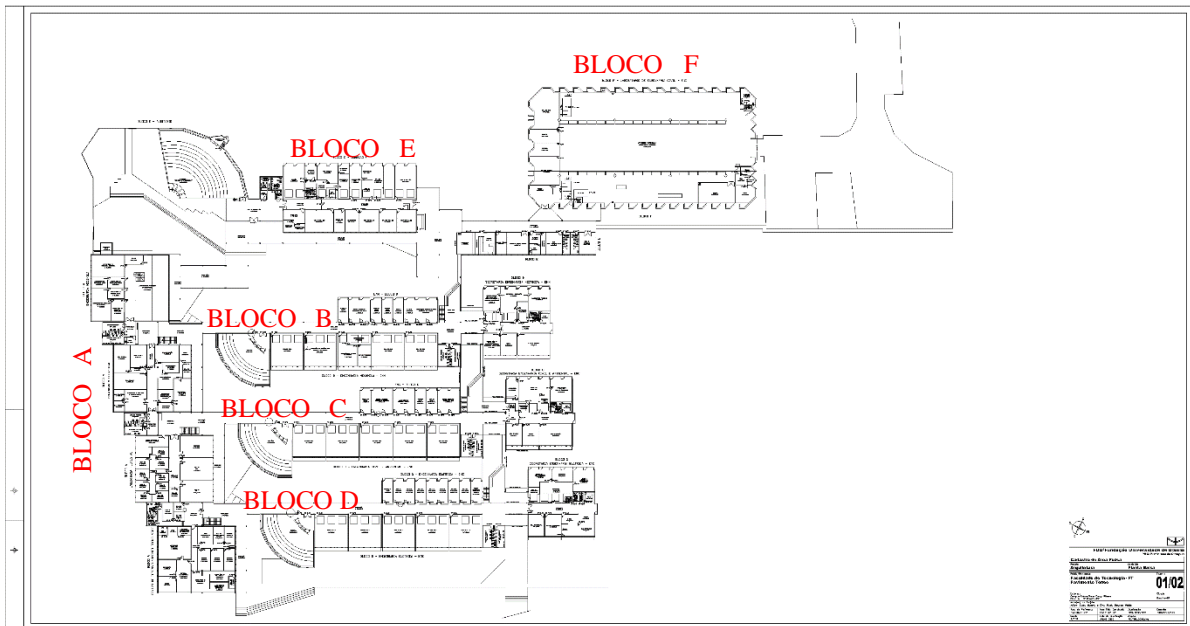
Planta baixa térreo da Faculdade de Tecnologia
